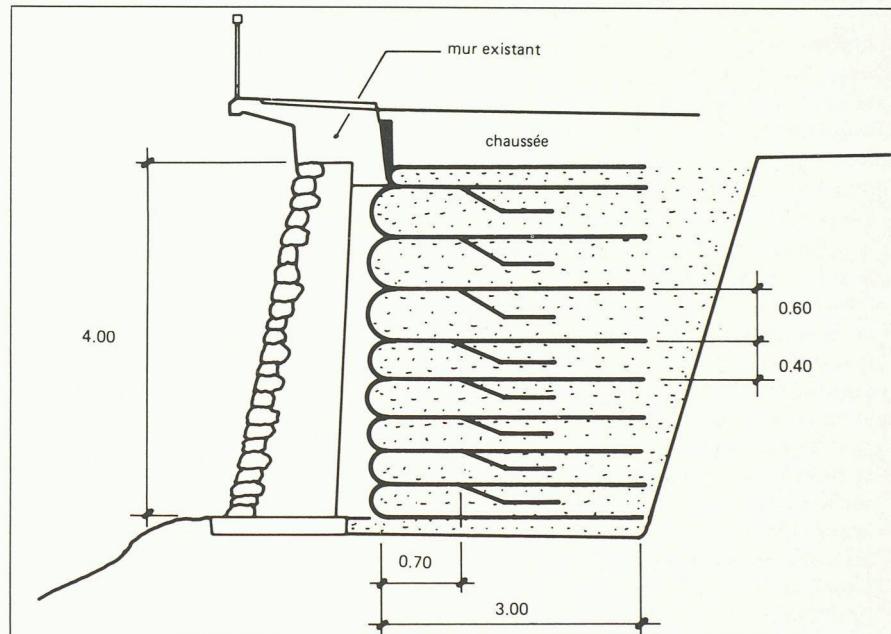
Profil en travers type du mur de soutènement et du massif en terre renforcée par des géotextiles, Langres (France) [6].
